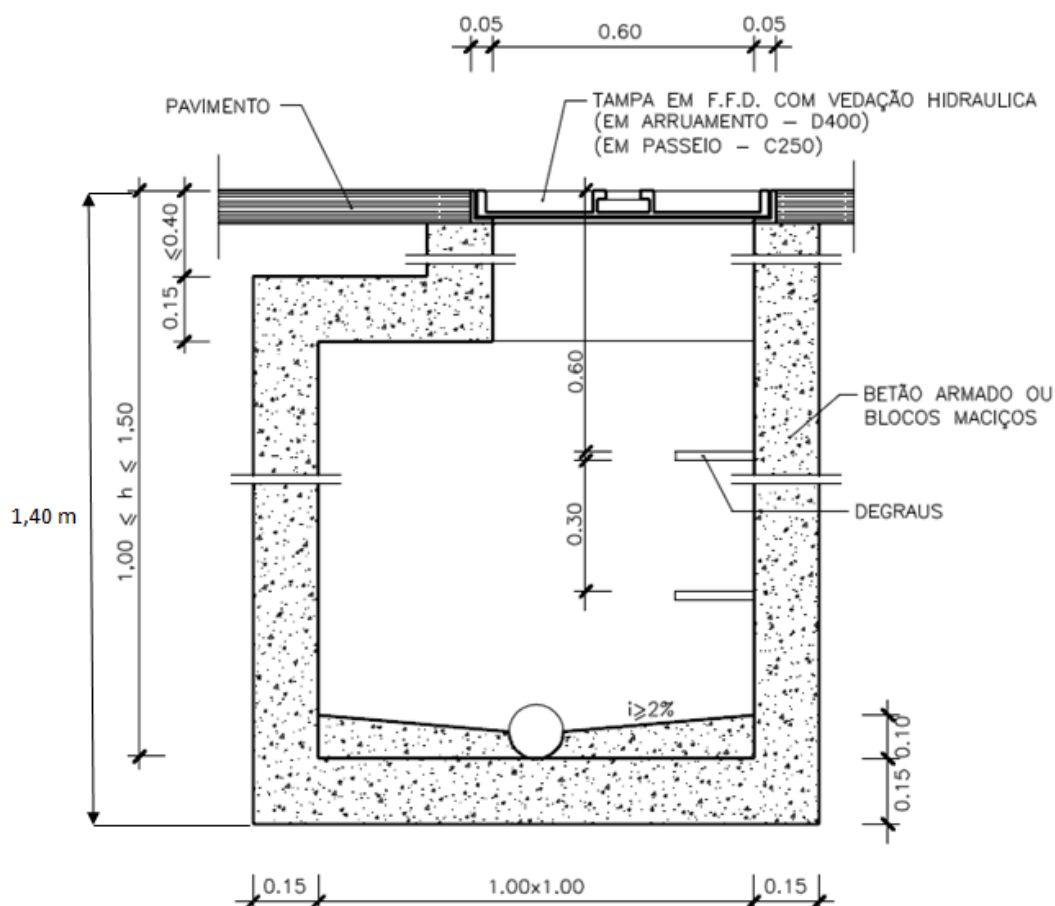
Corte longitudinal de uma CRL em betão (adaptado do “Pormenor de Câmaras de Ramal de Ligação - CRL” da Águas do Porto, 2015).
